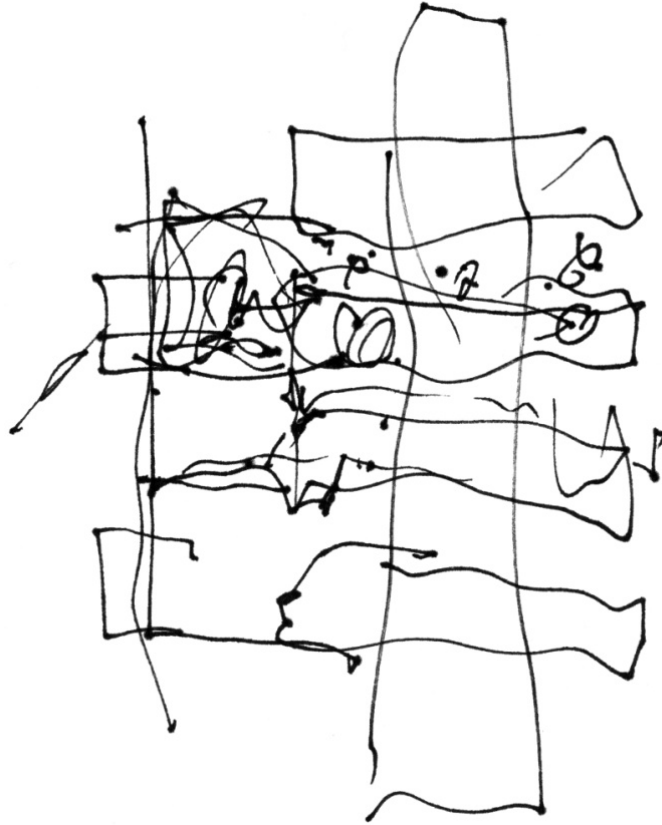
Frank Gehry. Boceto en alzado. Dr. Chau Wing Building. Sidney. Tinta sobre papel.
